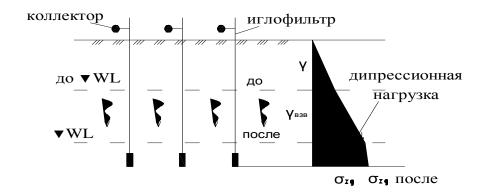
Схема уплотнения грунтов с помощью водопонижения иглофильтрами
